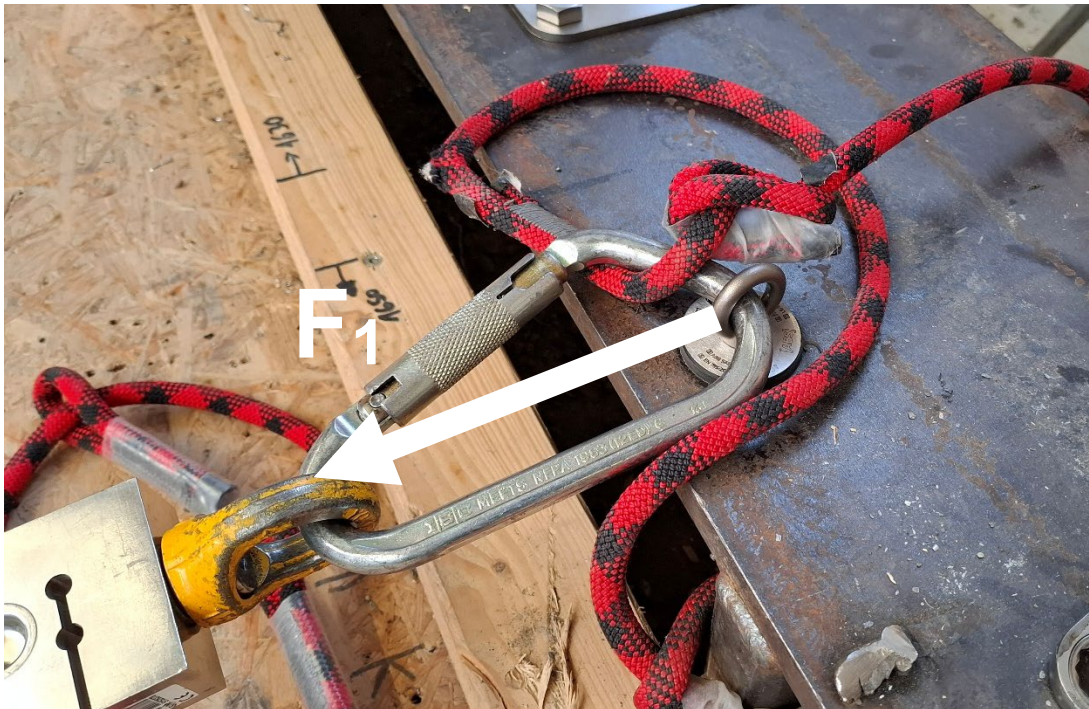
Prüfaufbau A, Anschlageneinrichtung, Typ: ABS-Lock® VI mit der Position und Richtung der Krafteinleitung
